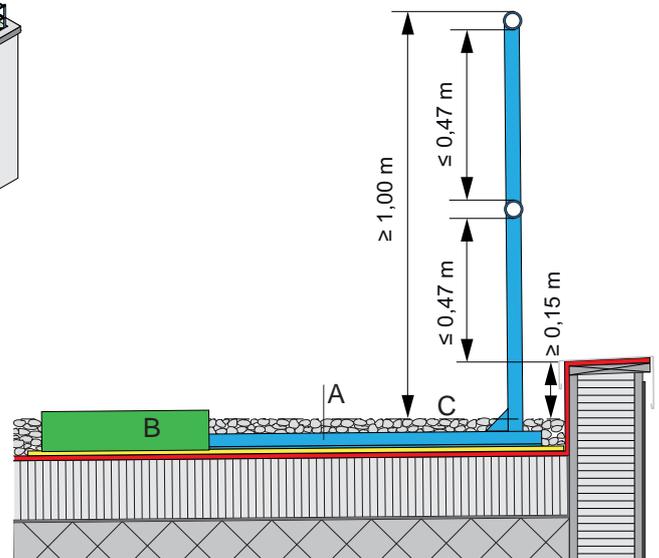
Classe d'équipement 3: Système de protection latérale (A) avec le poids de retenue (B) sur le revêtement du toit plat, cotes depuis la couche d'usure/de protection (C)
